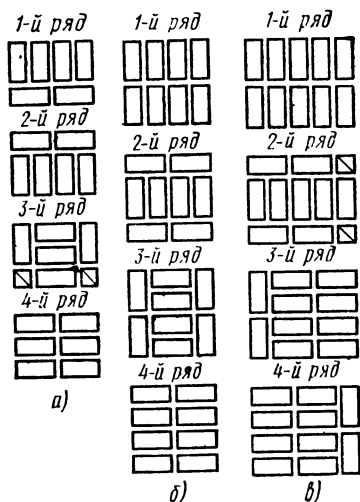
Порядовая раскладка кирпича по трехрядной системе перевязки швов при кладке столбов:
